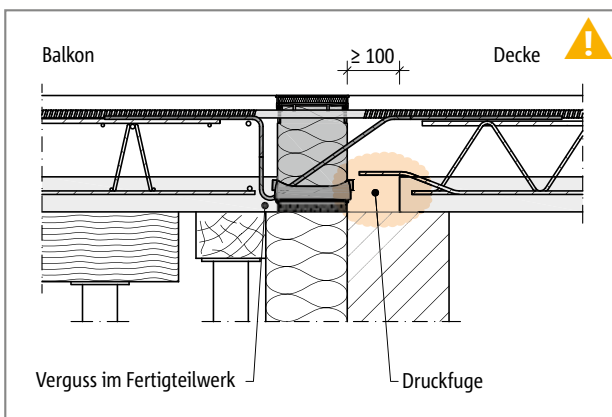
Schöck Isokorb® CXT Typ K: Direkte Lagerung, Einbau in Verbindung mit Elementplatten (hier: $h \leq 170$ mm), Druckfuge deckenseitig
